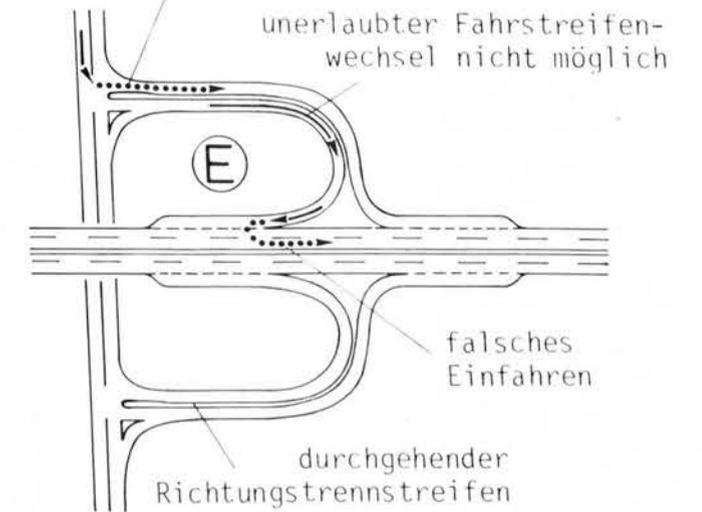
Hinweise zu baulichen Umständen bei Falschfahrten in Anschlußstellen
